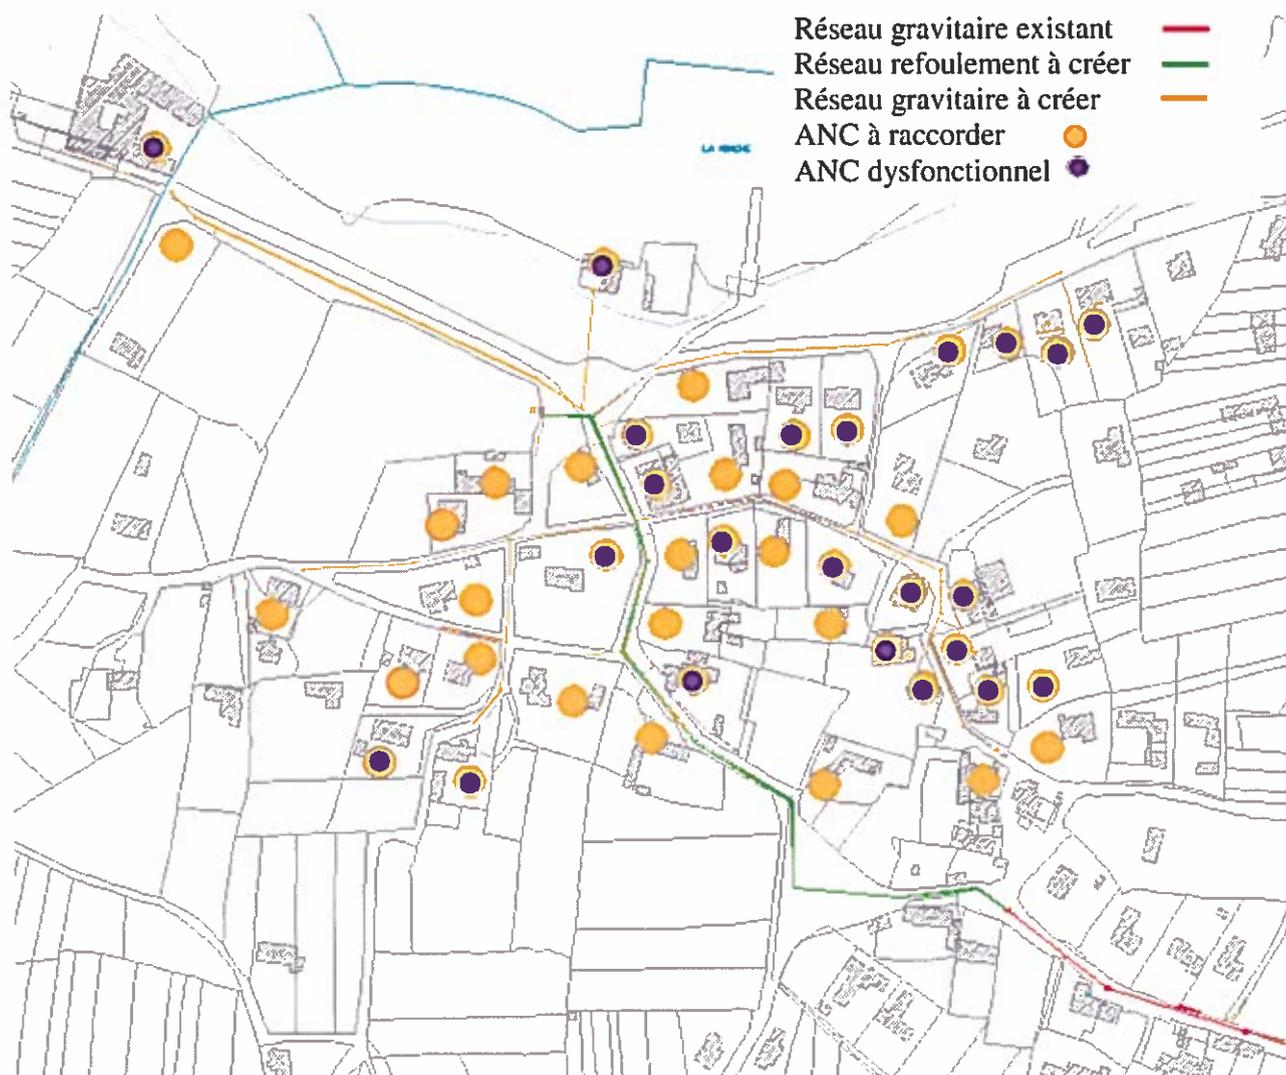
Plan de l'extension de réseau proposée et localisation des ANC raccordés
